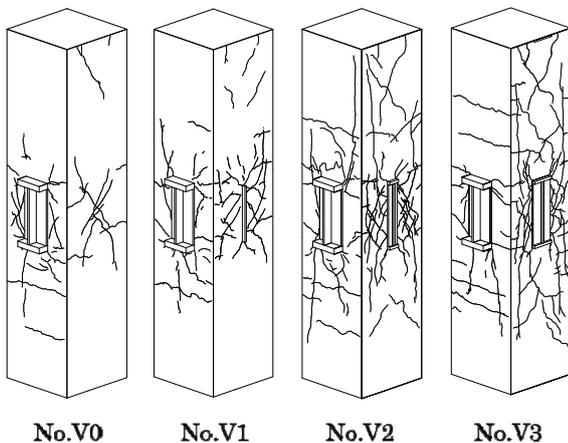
ひび割れ状況 ($R=20/1000\text{rad}$)
